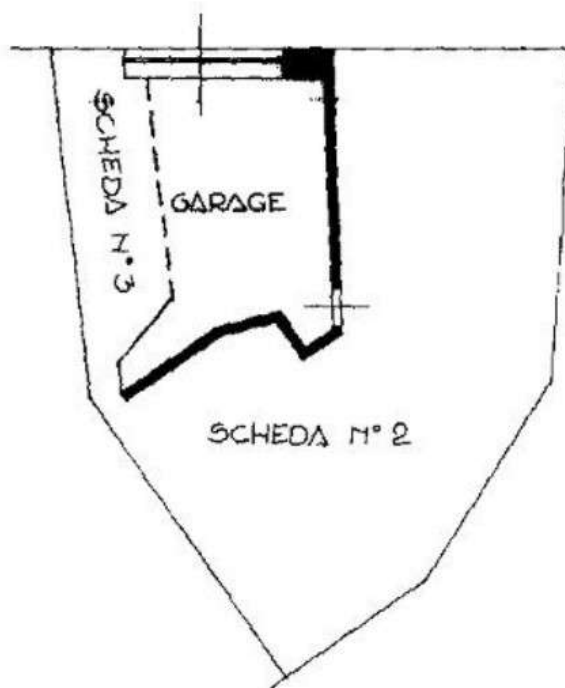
scheda n. 1 (garage estratto dalla planimetria catastale).
